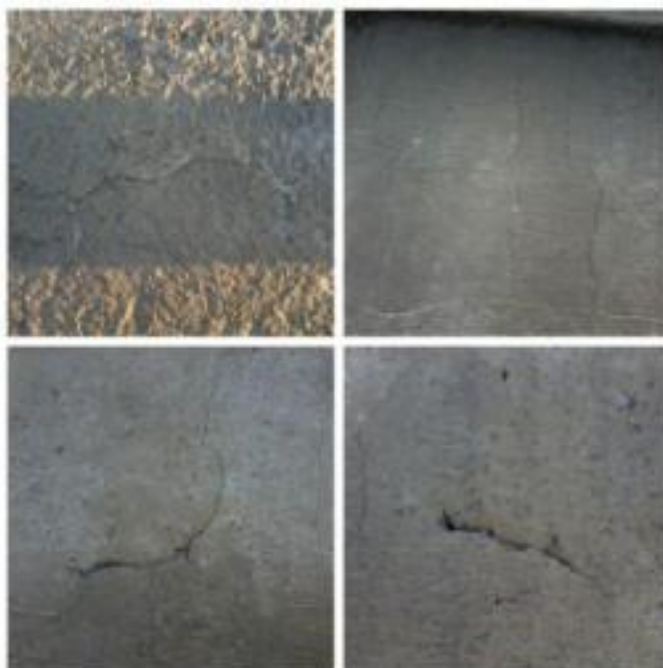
Fissuras causadas pela retração plástica na Concretagem 2
